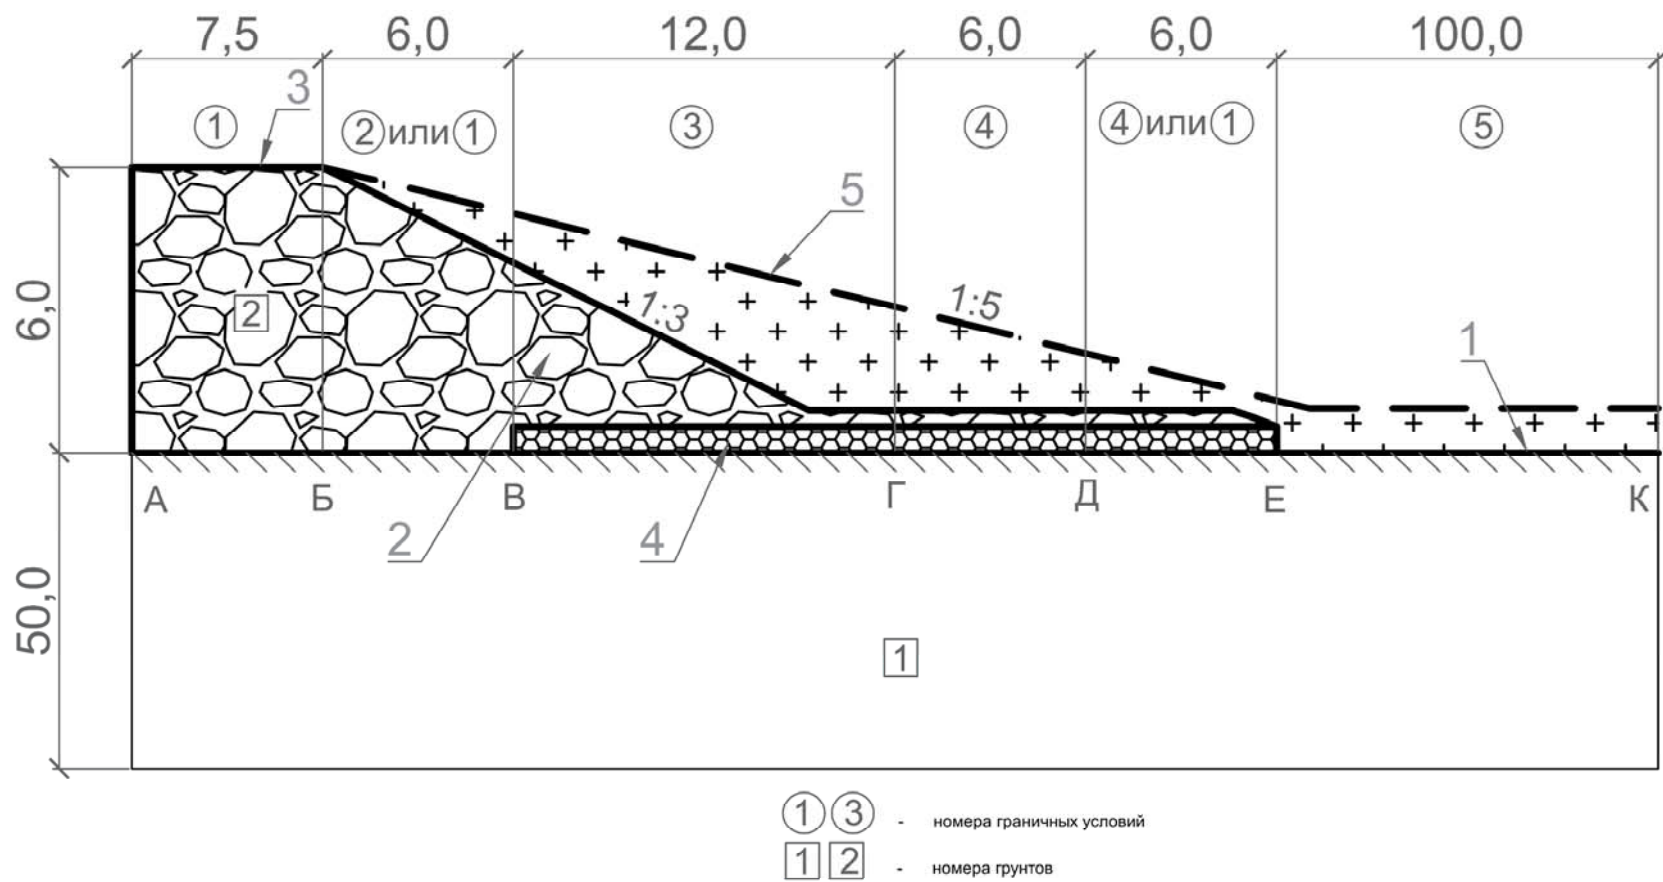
Схема насыпи: 1- естественная поверхность грунта; 2 – тело насыпи; 3- основная площадка насыпи; 4- теплоизоляция; 5 – поверхность снежных отложений
